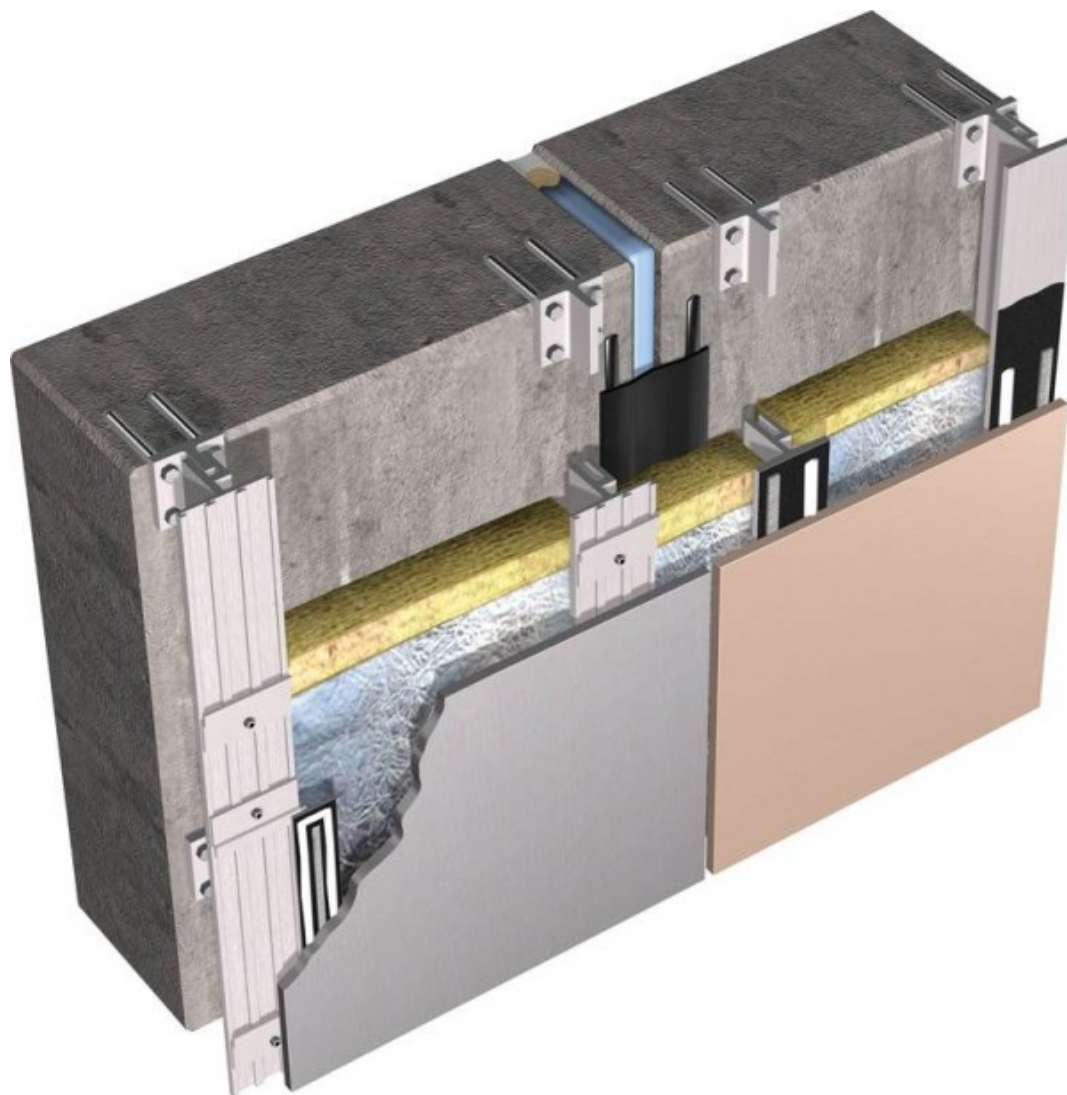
Разрез стены монолитного железобетонного дома с вентилируемым фасадом
